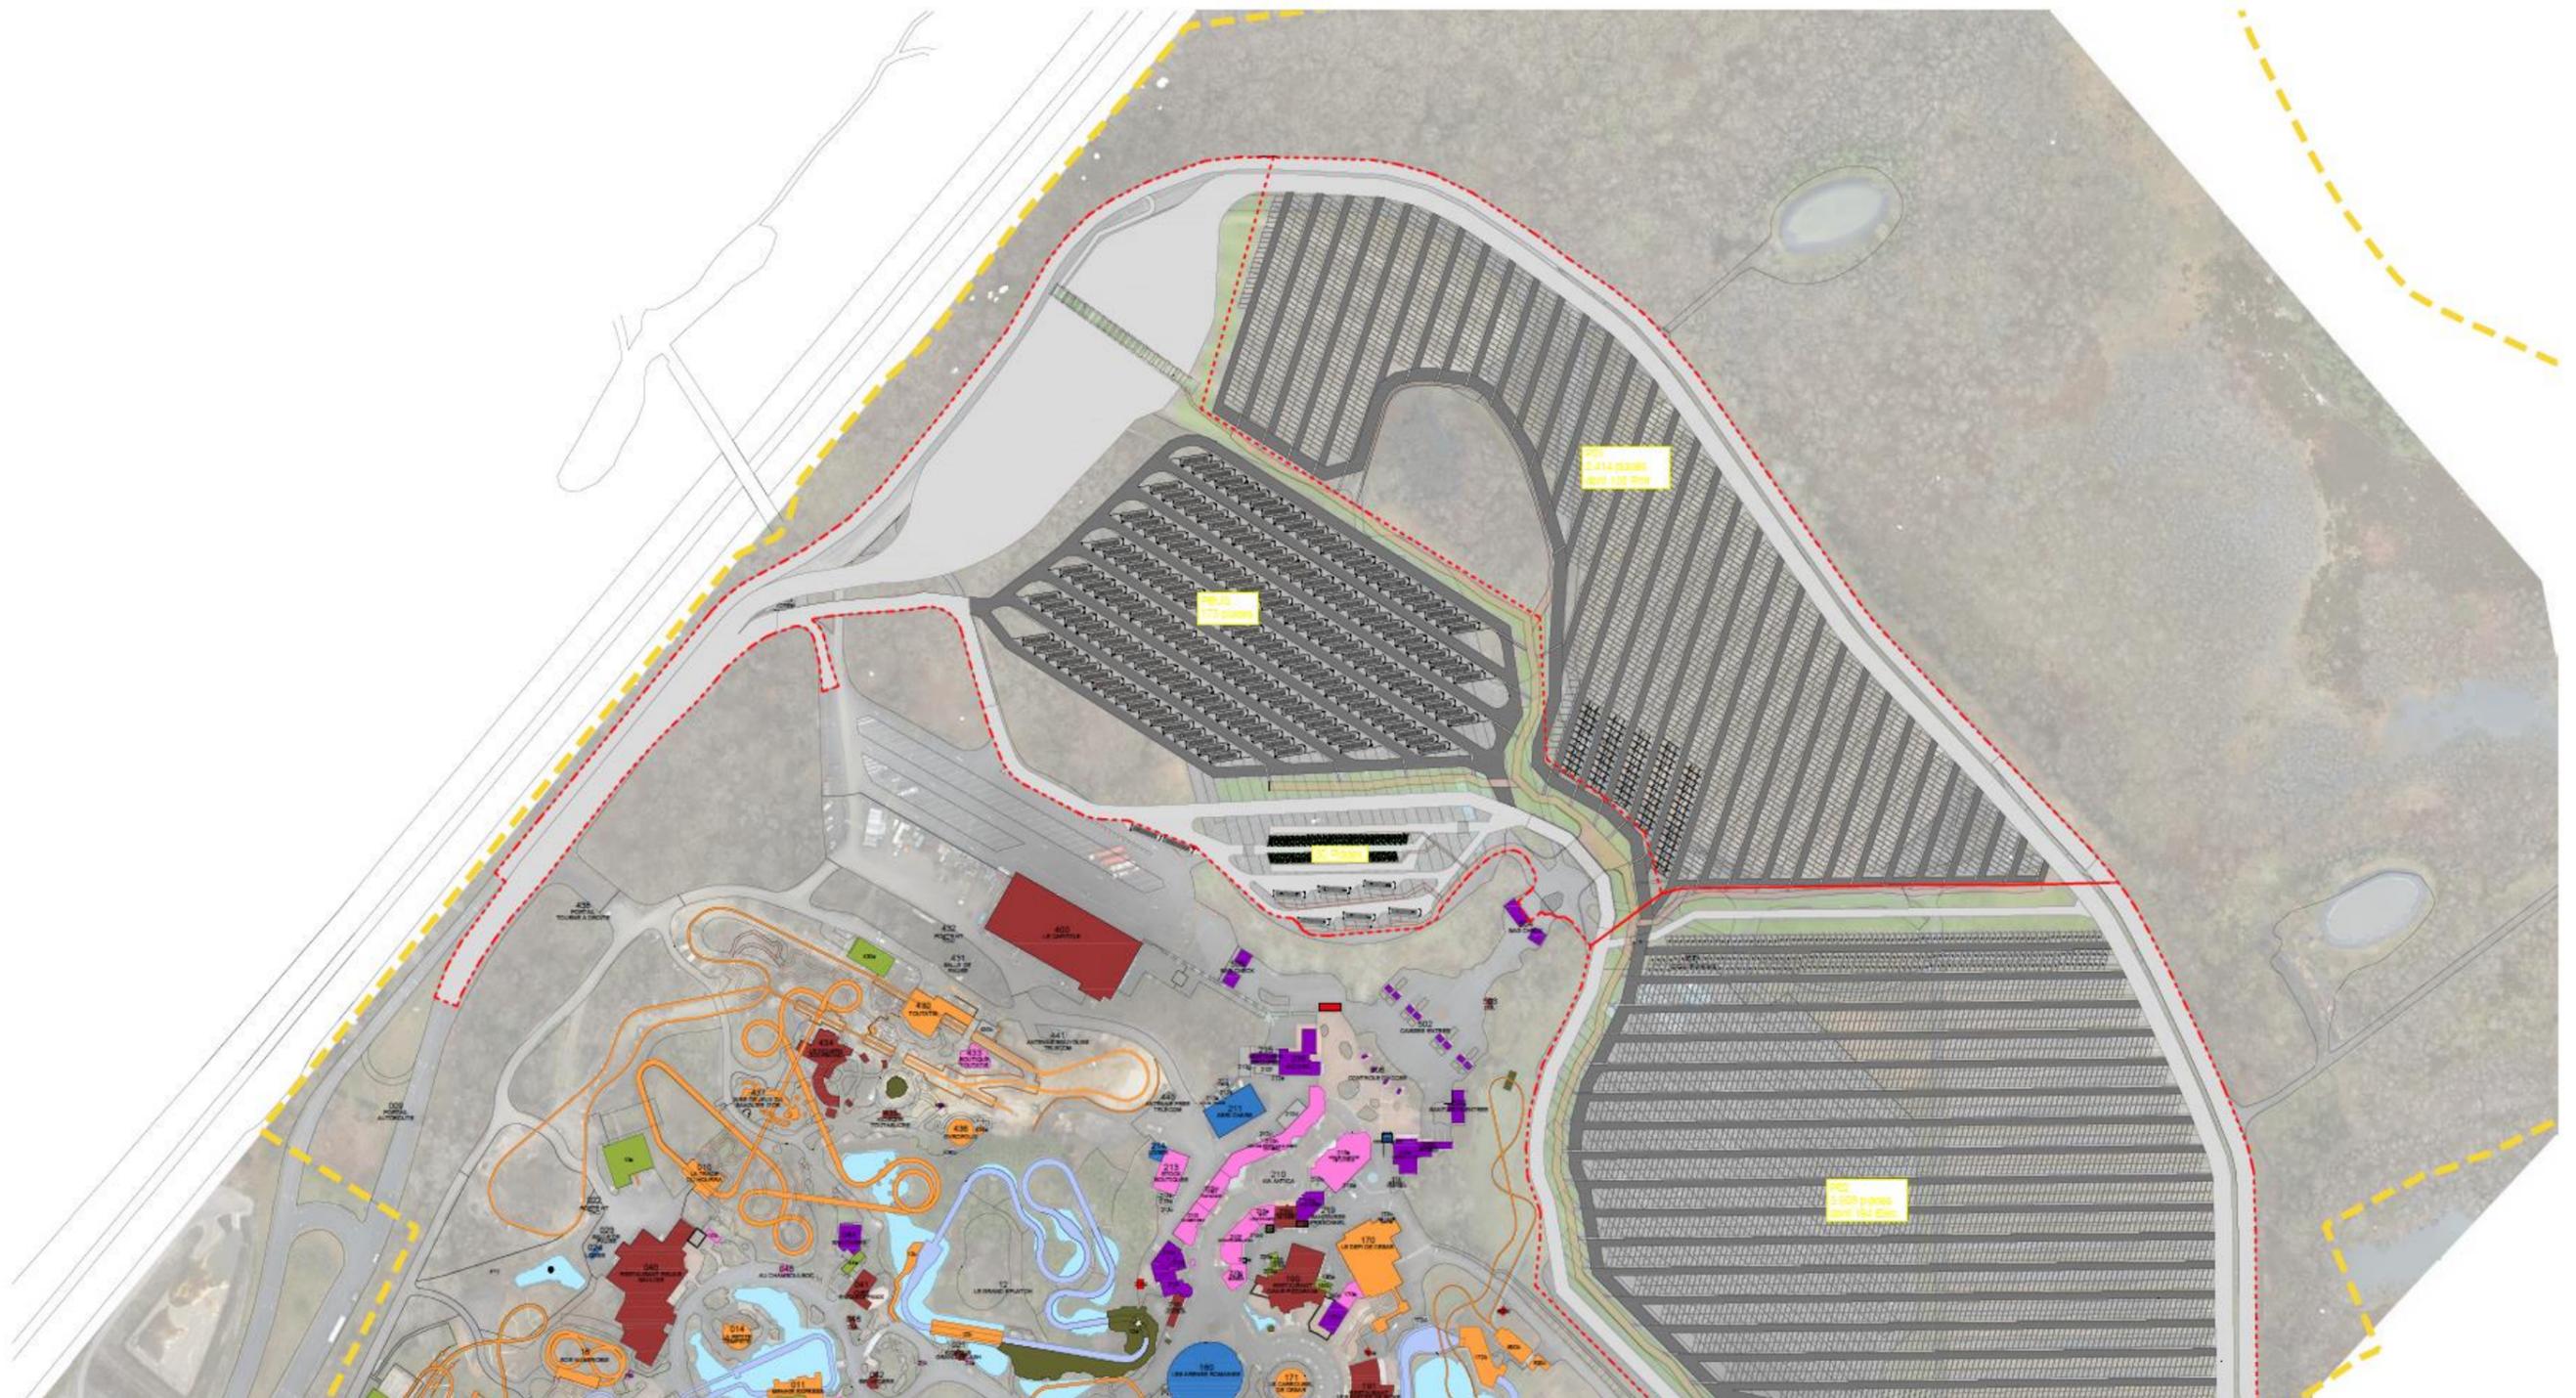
Plan de localisation des ouvrages hydrauliques – Plan 1/3 (Parc Astérix)
